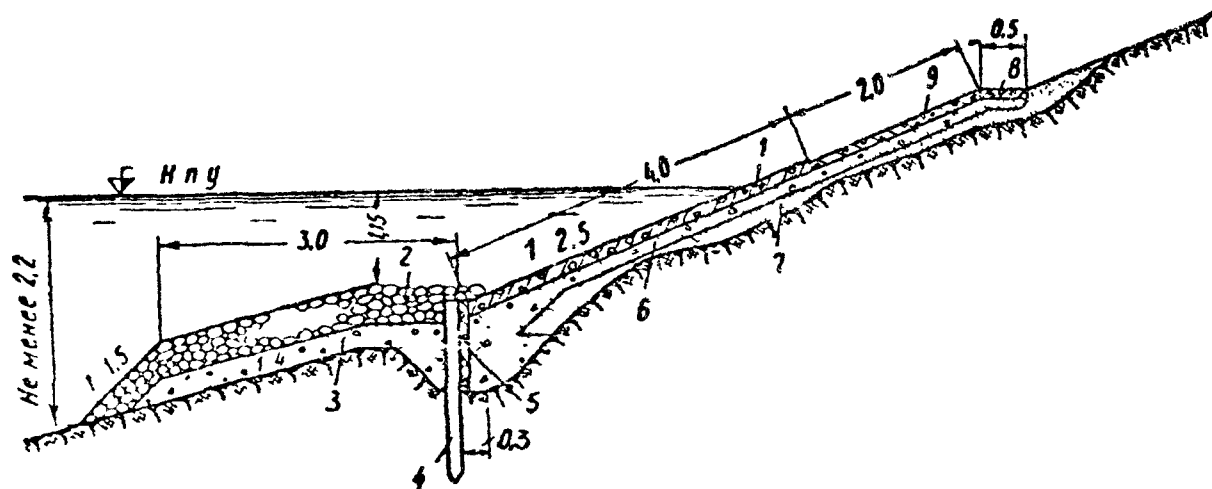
Поперечный разрез крепления откоса сборными железобетонными плитами, омоноличенными по контуру, на канале имени Москвы:
